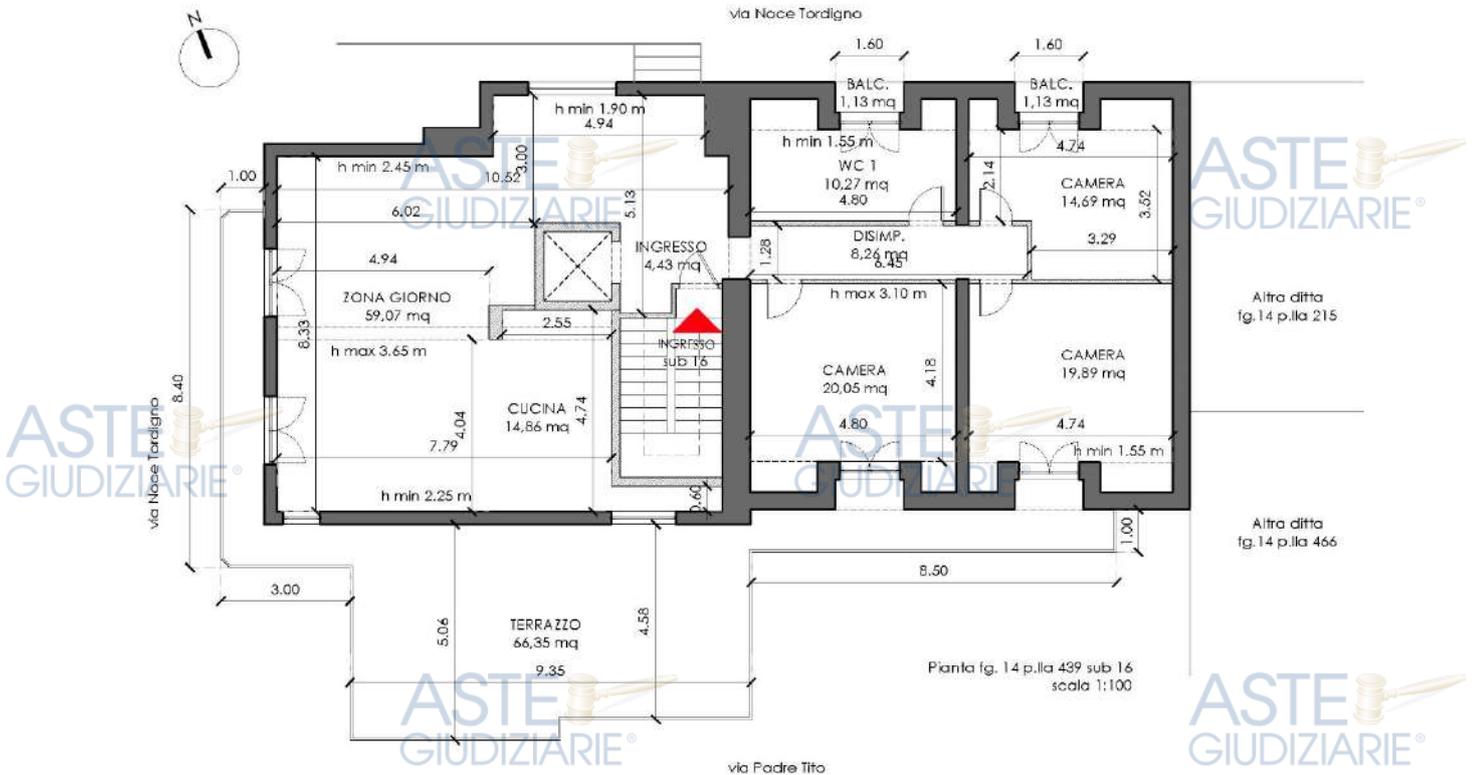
Rilievo Abitazione Lotto Uno Stato di fatto \_ pianta piano quarto (Allegato 6E)
